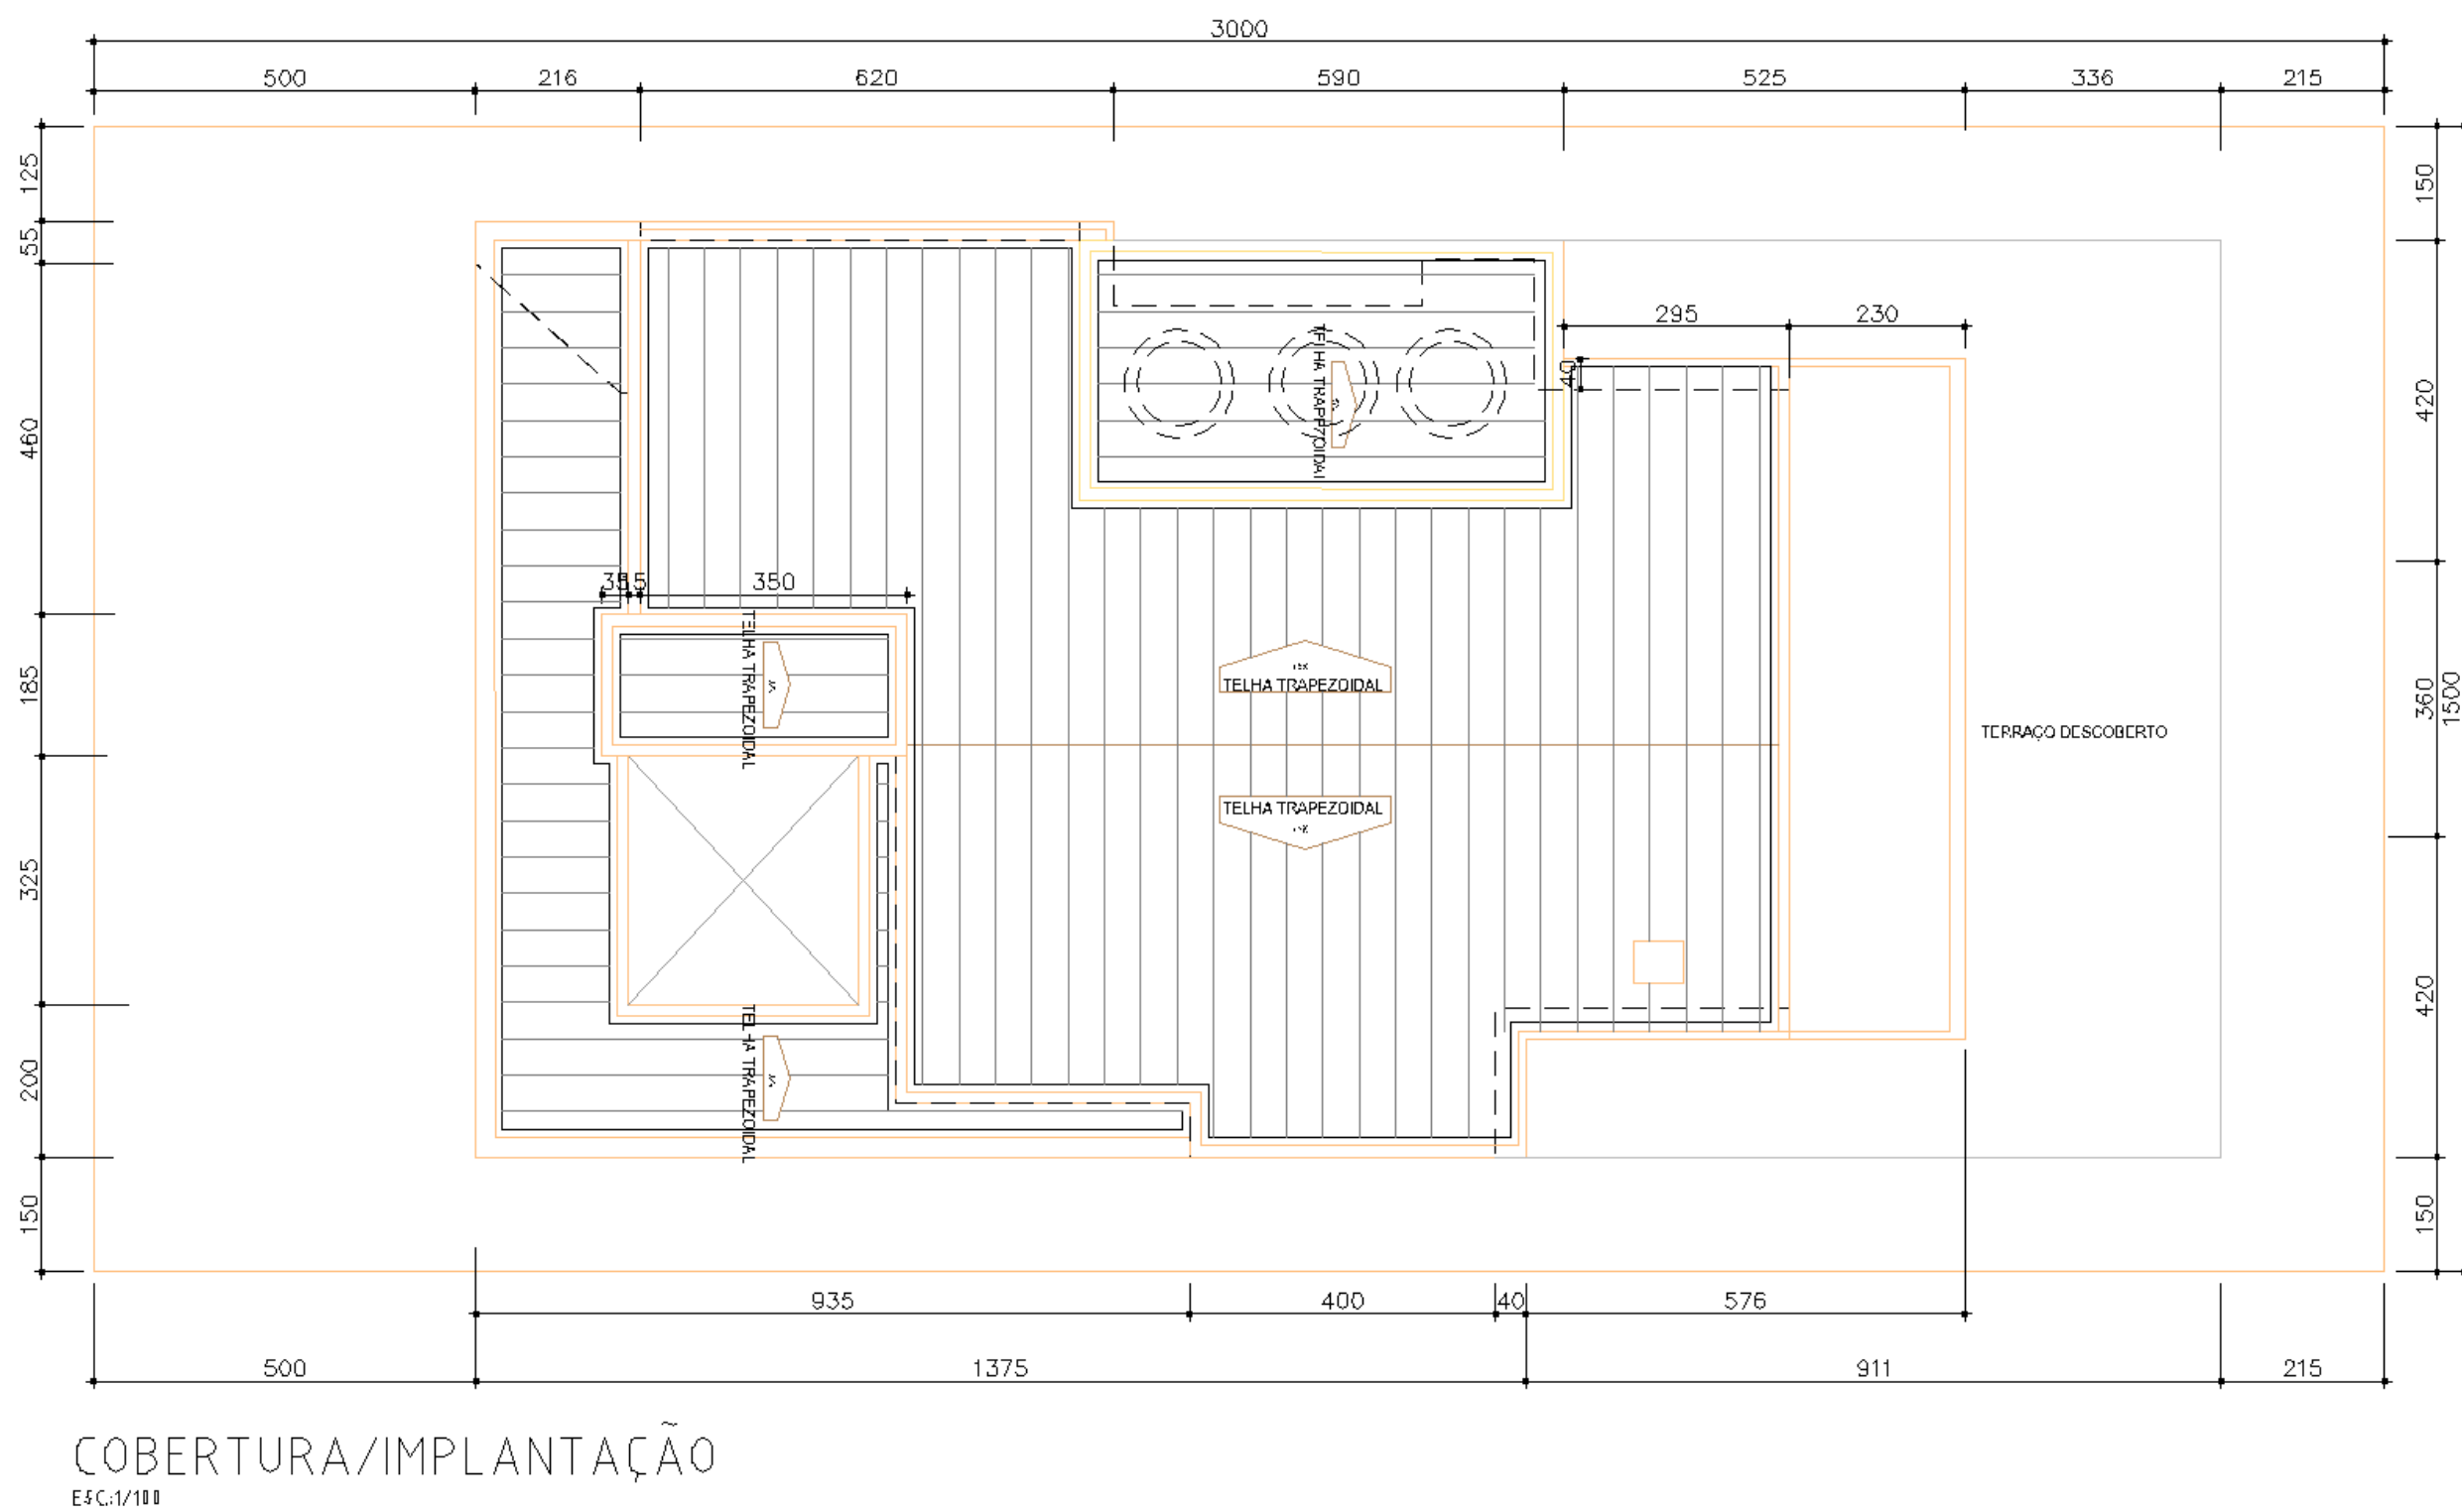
Planta Baixa Cobertura. Fonte: Autor
